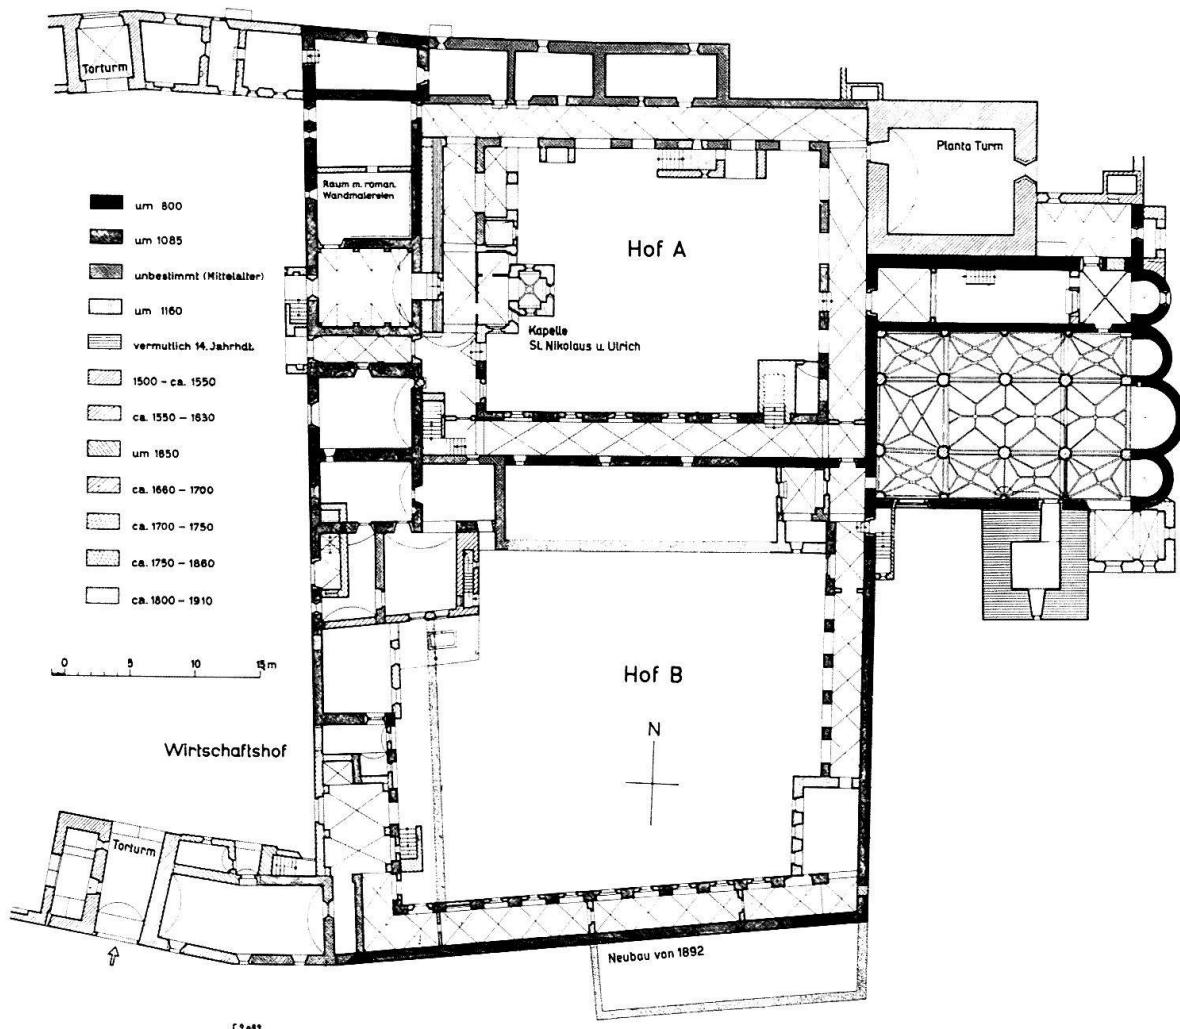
Müstair. Grundriss der Klosteranlage
